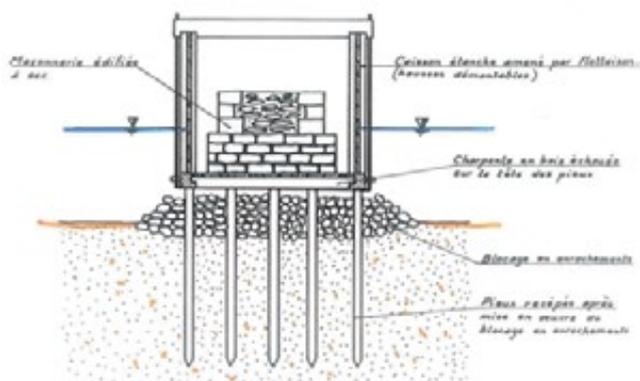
Fondation sur pieux et caisson échoué (crédit J-P Levillain)
